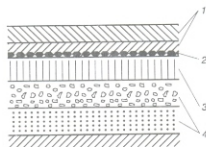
Армирование асфальтобетонного покрытия автомобильной дороги: 1 – верхний слой покрытия из асфальтобетона; 2 – геосетка; 3 – нижний слой асфальтобетона или несущий слой основания из материала, обработанного вяжущим; 4 – слой основания
